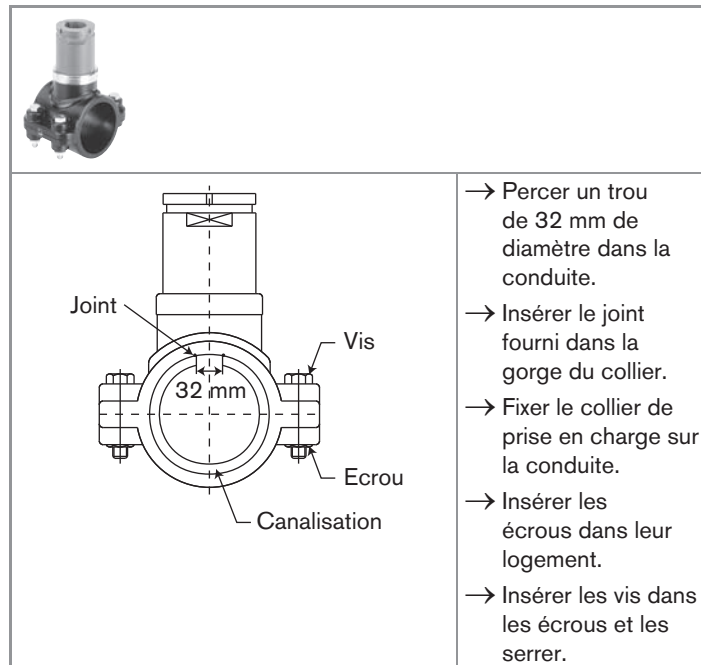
Installation d'un raccord avec collier de prise en charge
